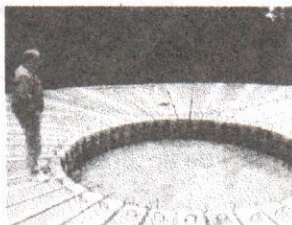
Detaliu rezemare grinzi prefabricate de acoperiș.
